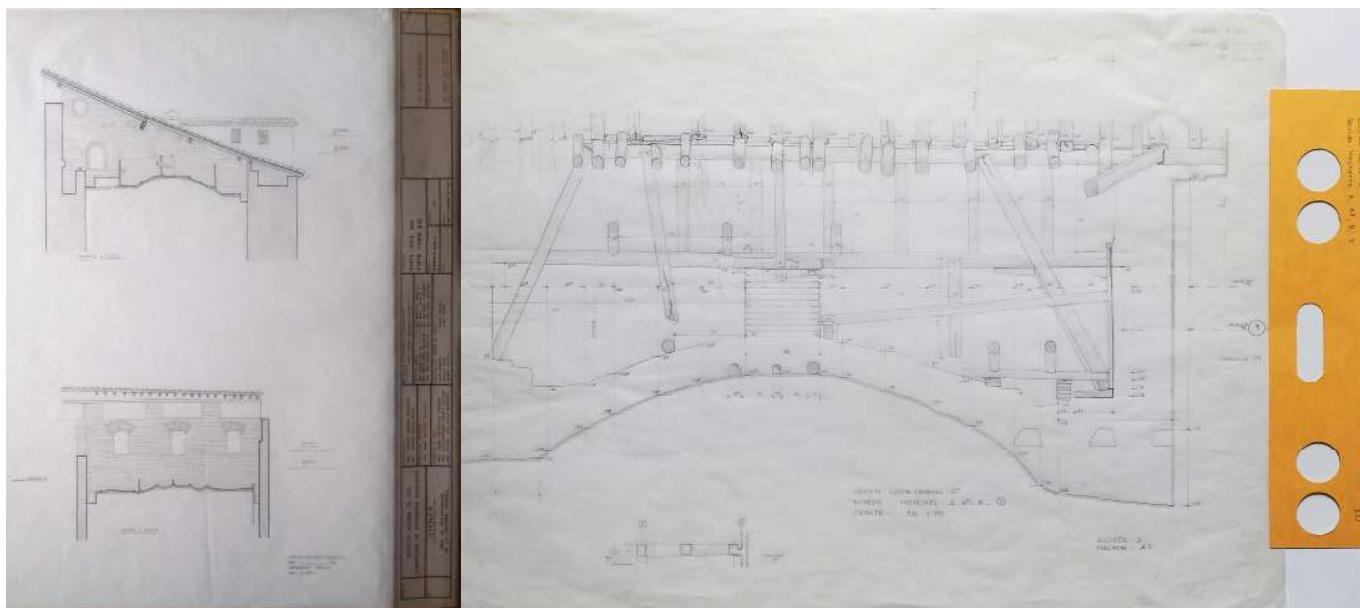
CIVILCO. Planos de levantamiento elaborados durante la restauración de la cubierta de la catedral. 1995 (AHCB)
